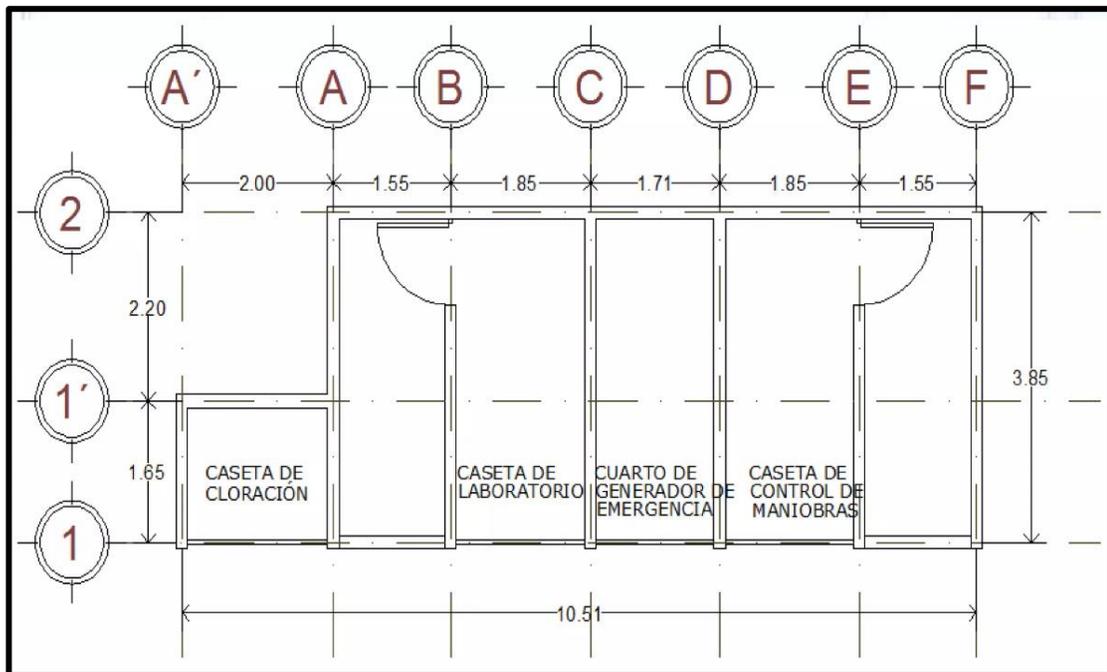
Plano de distribución de la planta de tratamiento propuesta.
